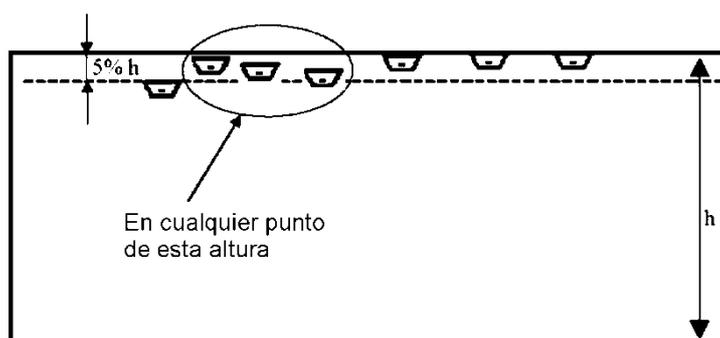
Emplazamiento y separación bajo falsos techos
